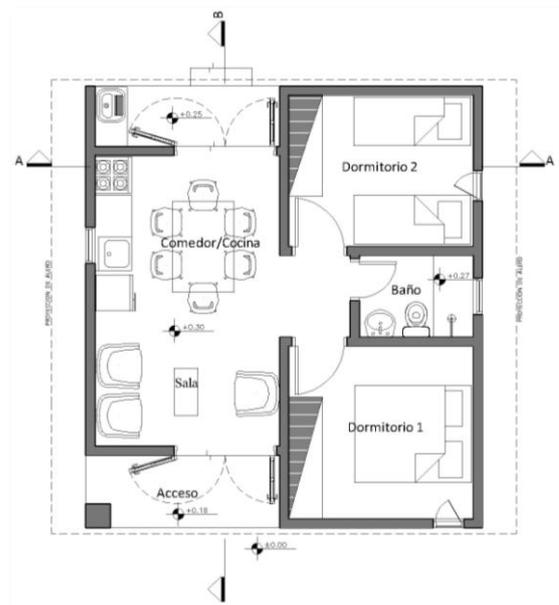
Vivienda Rural Che Tapyi - 47,08 m²
